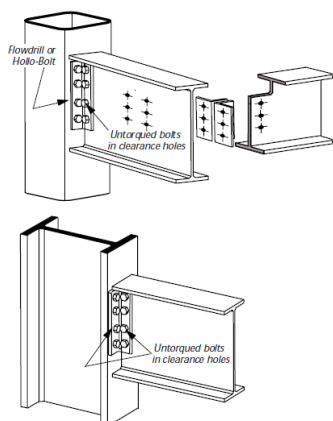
Ligação viga-pilar e viga-viga com dupla cantoneira (SCI/BCSA, *Joints in steel construction - simple connections., 2006*)
